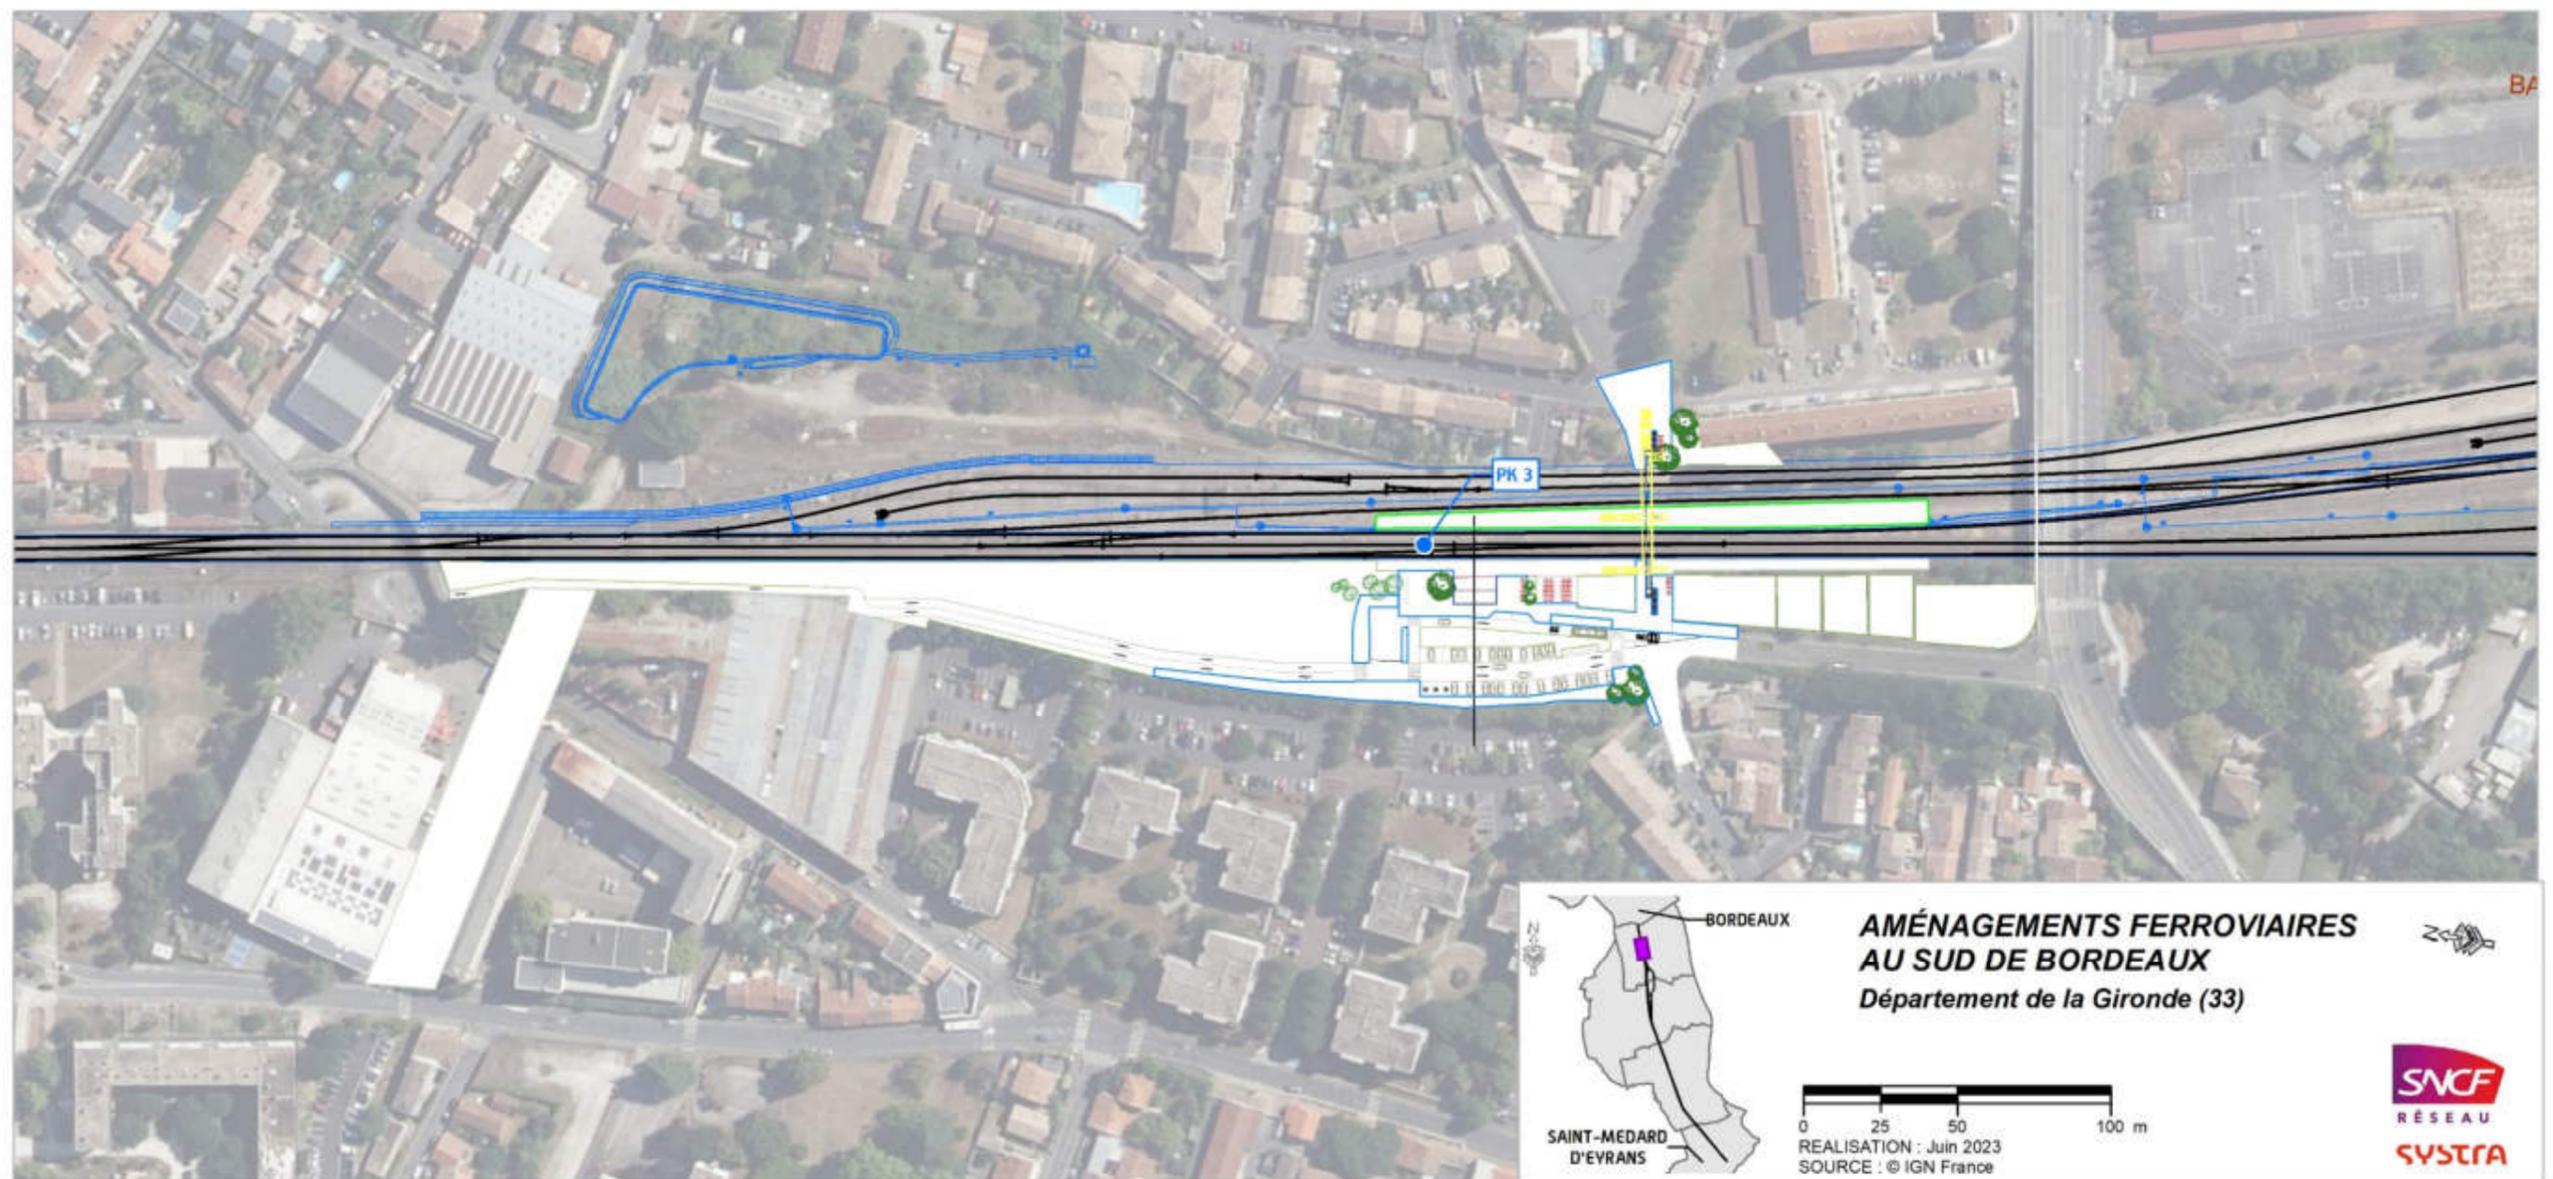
Vue en plan du PEM et de la gare de Bègles
